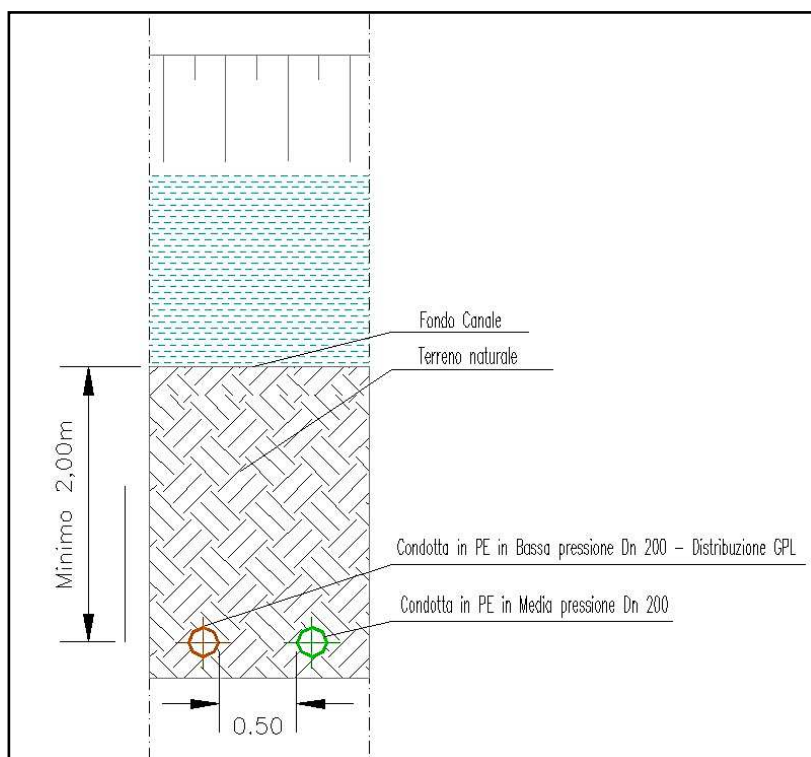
Sezione di progetto in corrispondenza del letto del canale.
